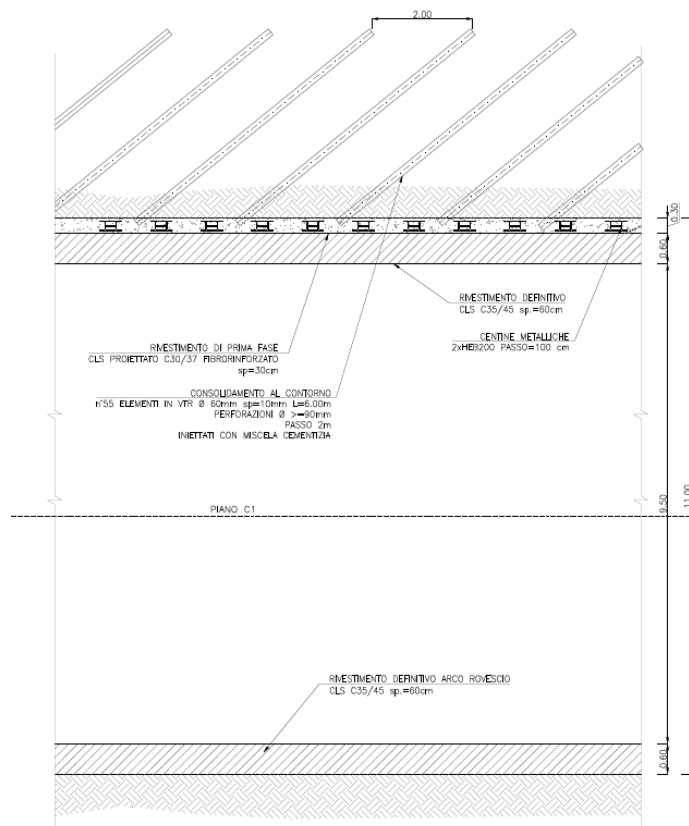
Sezione tipo D4: geometria del cavo e interventi di sostegno, sezione longitudinale
